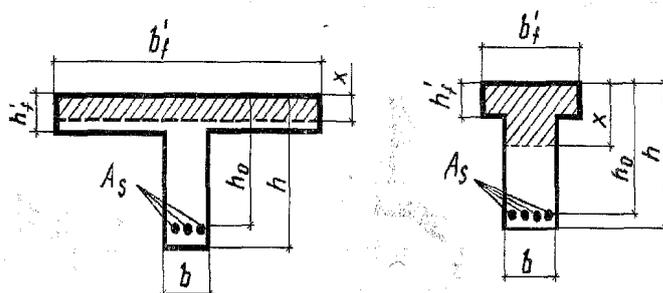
Два расчетных случая тавровых сечений; расположение границы сжатой зоны в пределах полки и ниже полки
